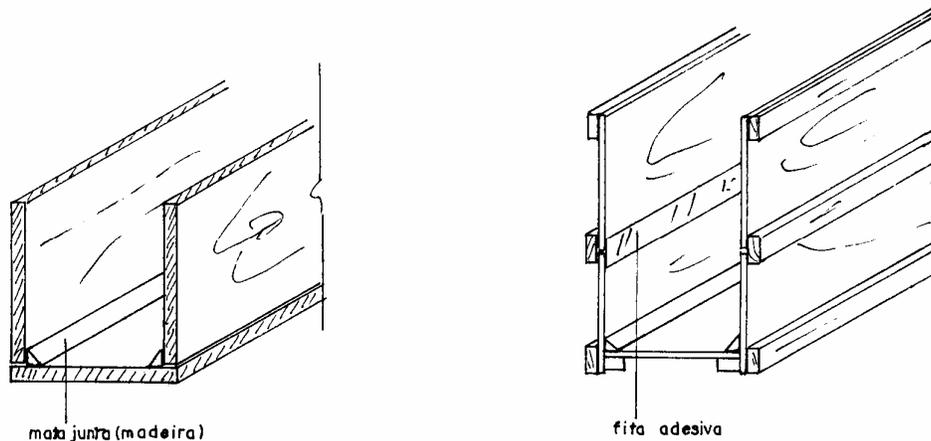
Detalhes da fôrma das lajes maciças conjugado com vigas
